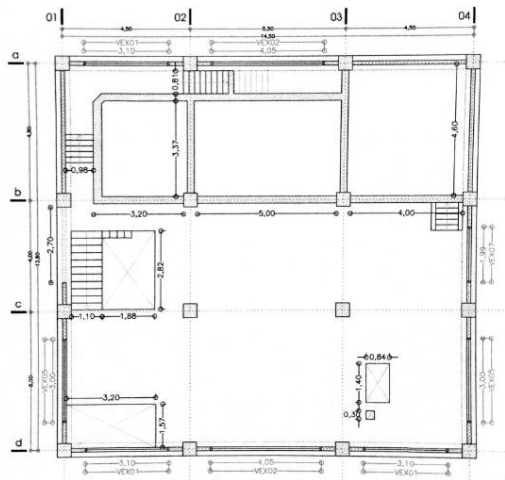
Plano actual y reformado de la primera planta del Lavadero de carbón del Pozo Casares en Tremor de Arriba. Fuente: plano del estado actual: Francisco De Borja Menéndez y Paula Núñez Álvarez, «Proyecto de rehabilitación del Lavadero Casares para Centro temático de la miel en Tremor de Arriba», 2024, Archivo del Ayuntamiento de Igüeña; plano estado reformado: reelaboración propia.
